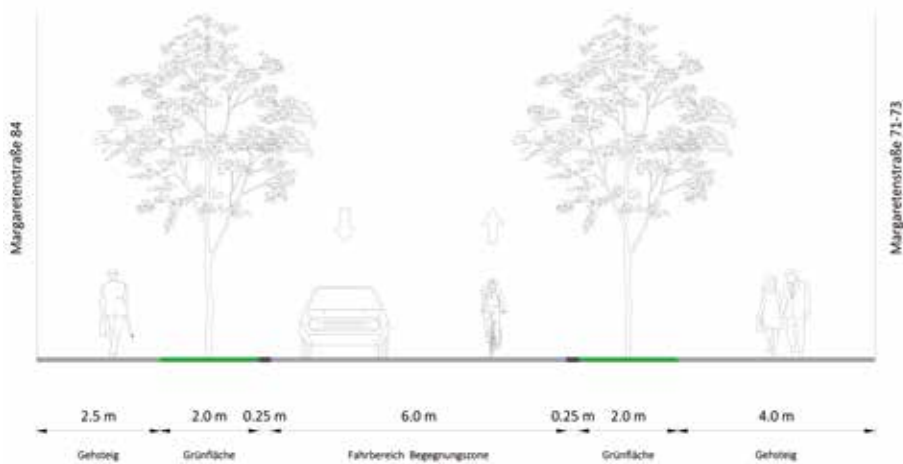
Querschnitt 2: Margaretenstraße 84, Richtung Nordosten
